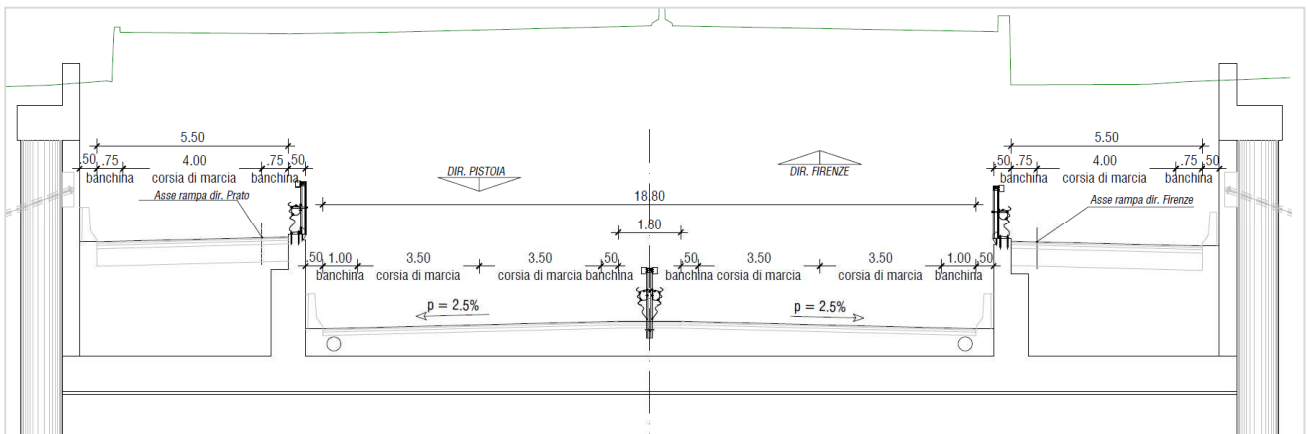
Sezione tipo "ASSE PRINCIPALE CON RAMPE IN AFFIANCAMENTO"
